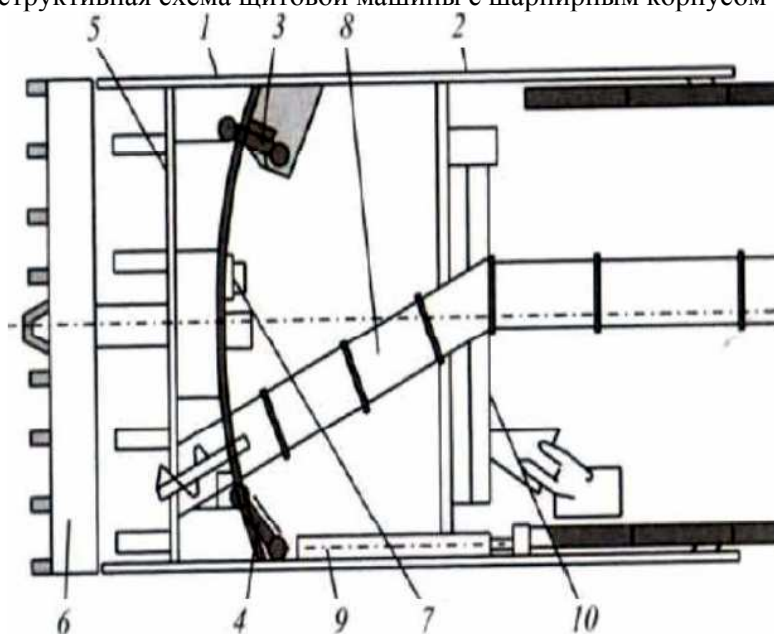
Конструктивная схема щитовой машины с шарнирным корпусом третьего вида
